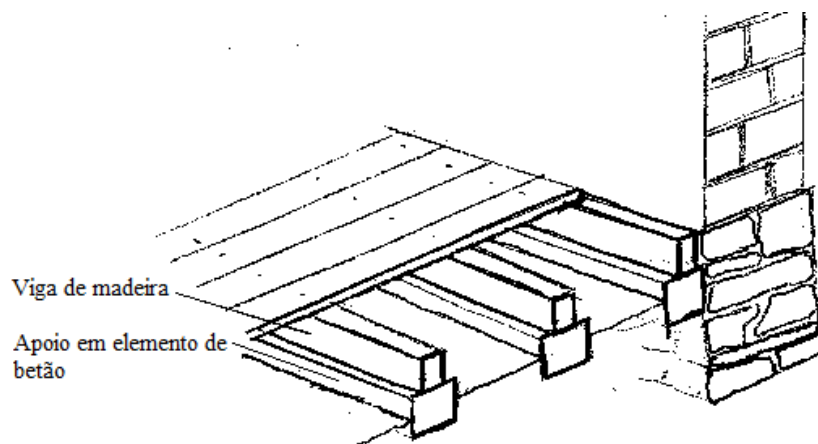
Reforço de pavimento interior em madeira, com introdução de elemento de betão para apoio das vigas de madeira, (Fonte: de autor)
